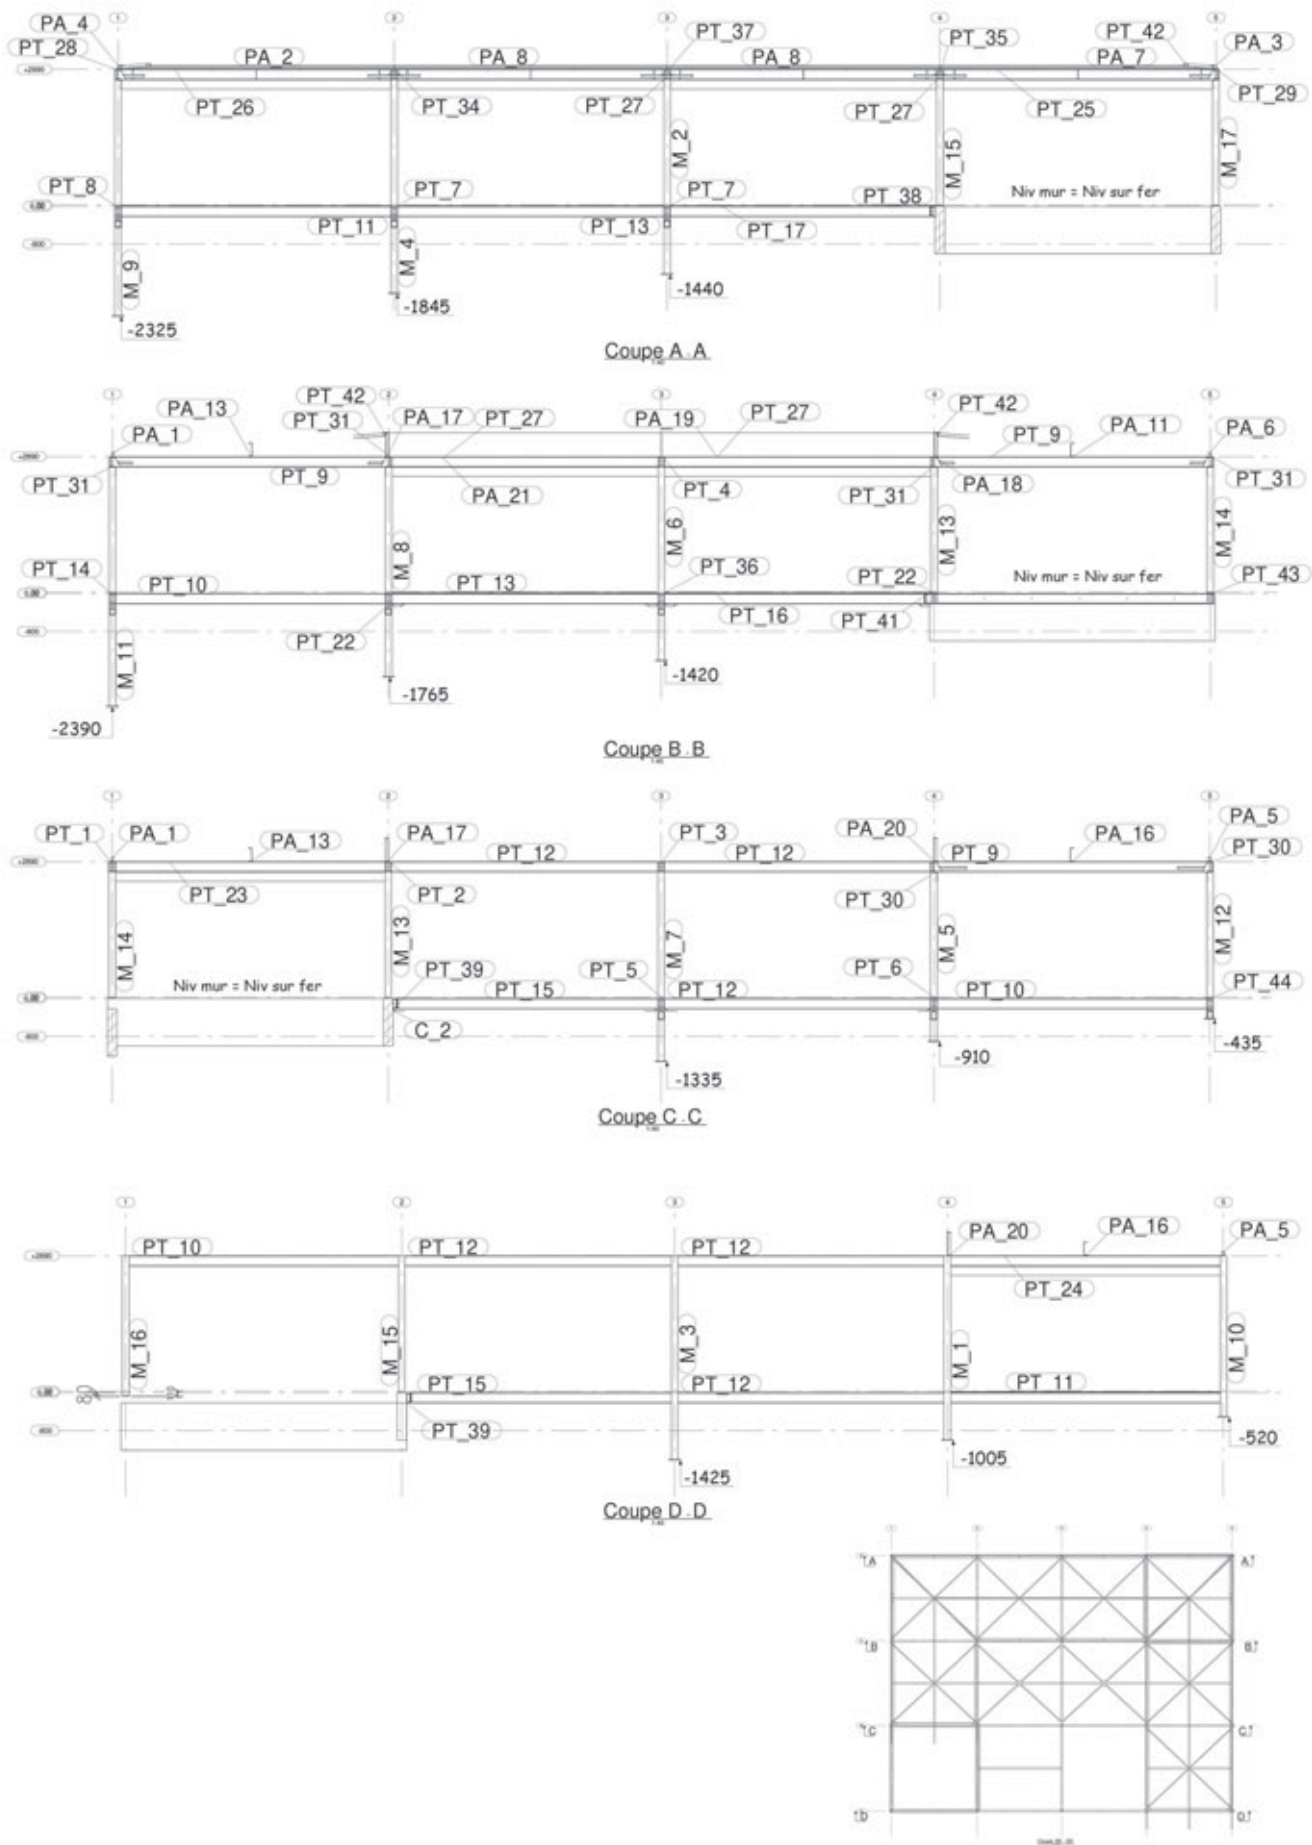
| Sezioni longitudinali d'assieme degli elementi strutturali.
